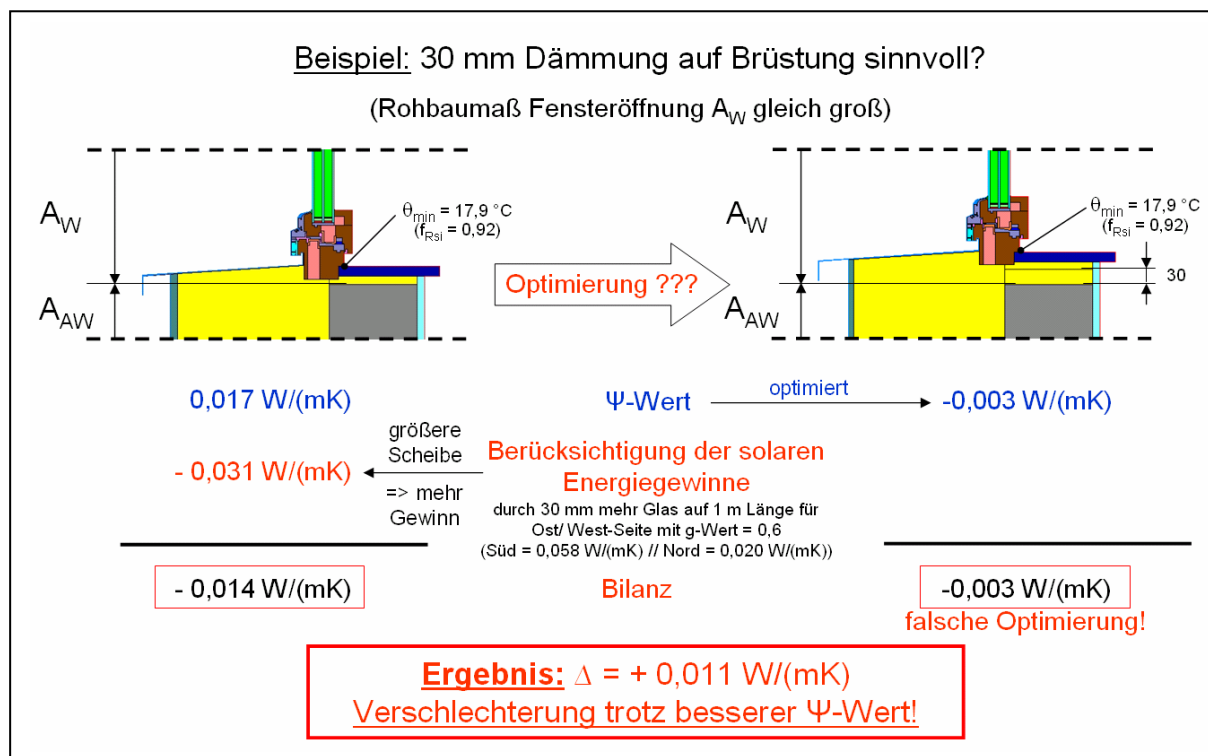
Einbausituation Fenster mit und ohne Dämmplatte auf Brüstung
